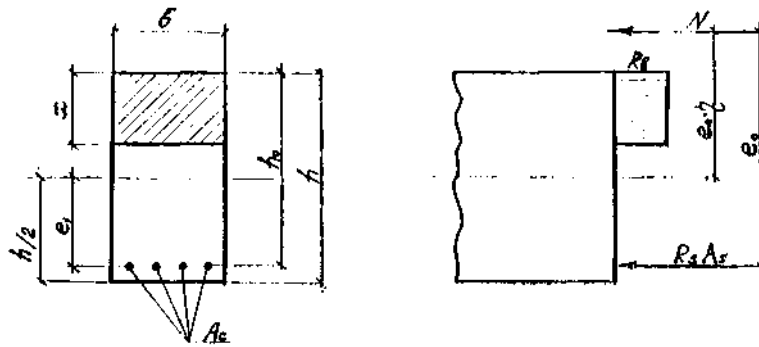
Схема к расчету внецентренно сжатых железобетонных элементов
